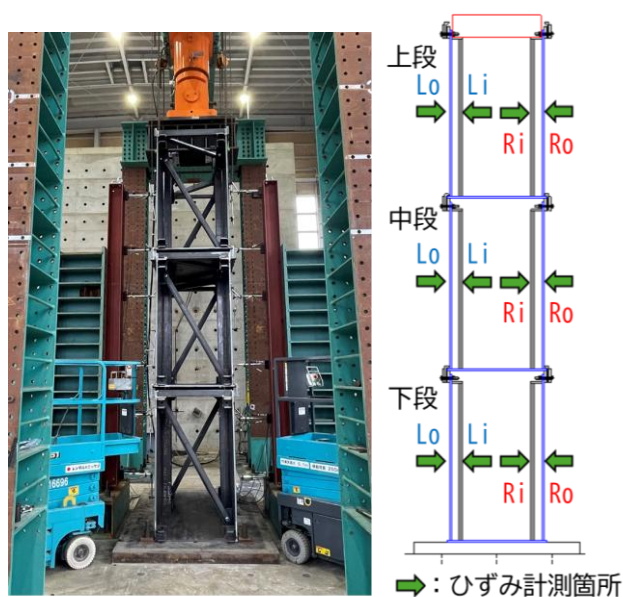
载荷試験状況 図-6 ひずみ計測箇所
